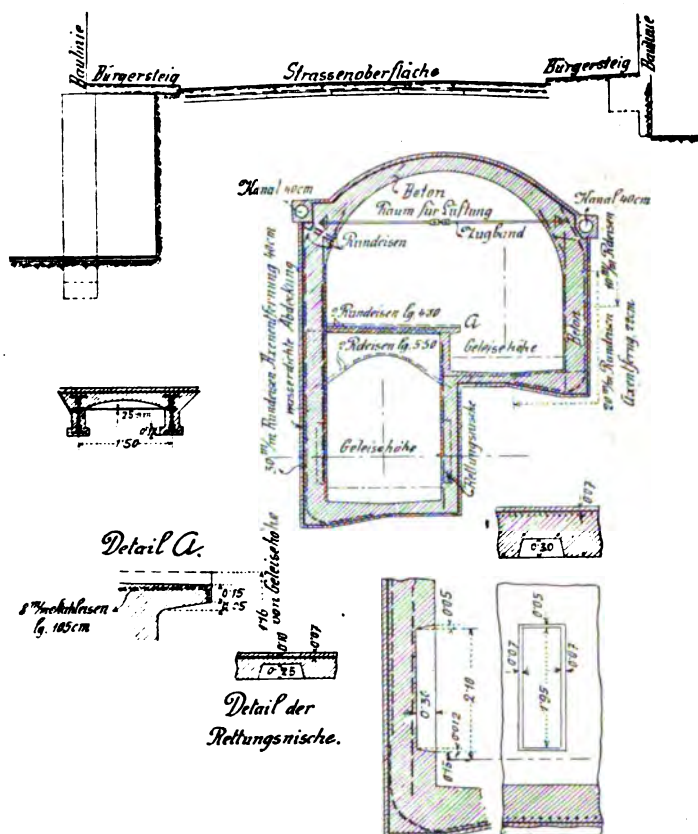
Querschnitt und Einzelheiten der Bausektion 5 des Washington-Street-Tunnels.
